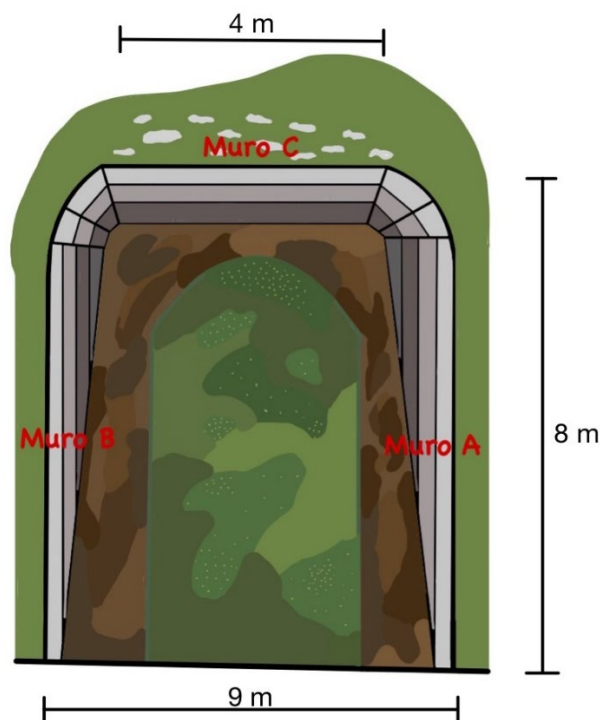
Vista en planta de la reconstrucción del conjunto de muros.
